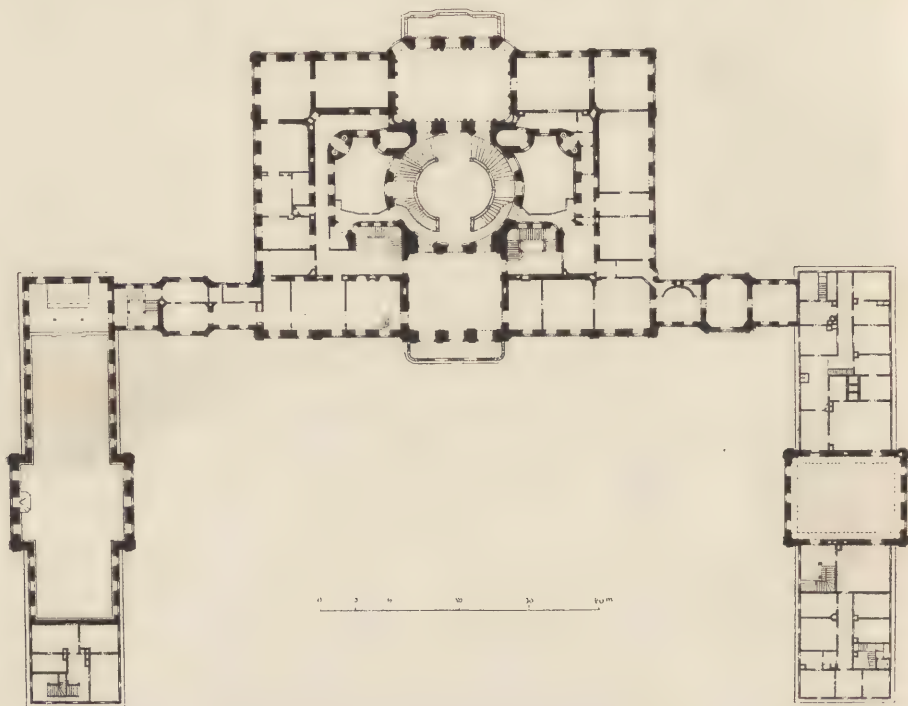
Schloss Bruchsal. Grundriss des Hauptgeschosses.
